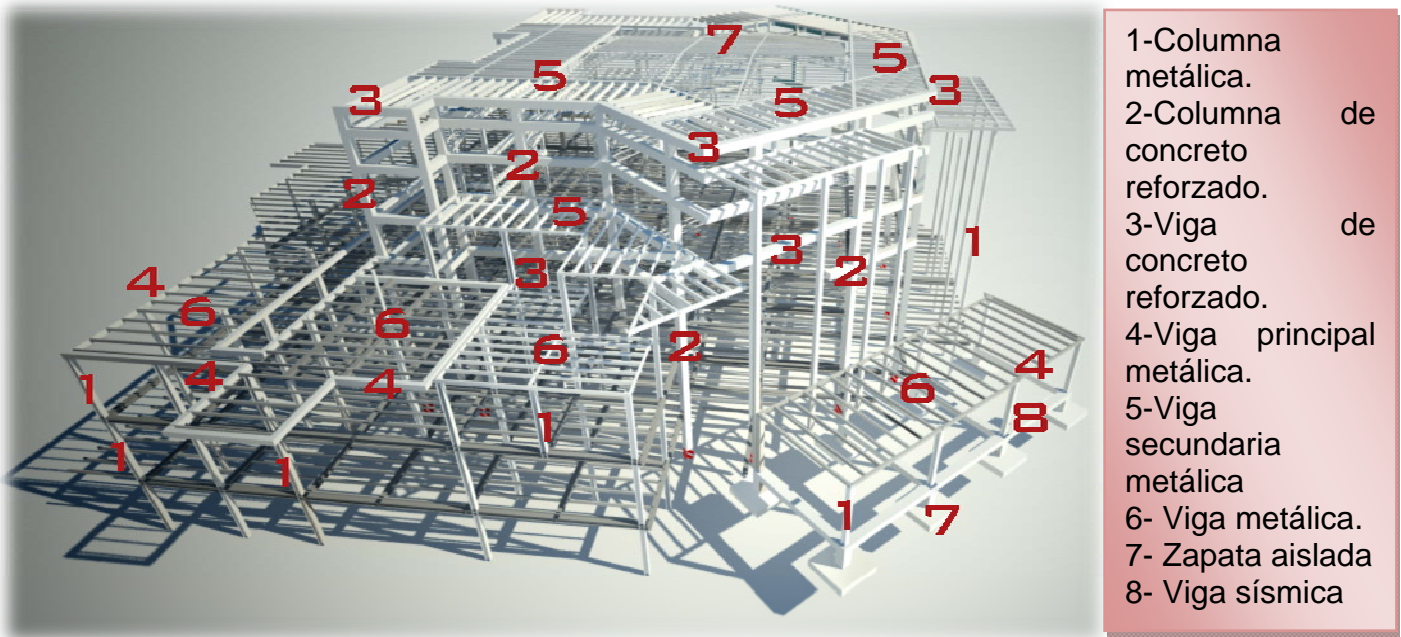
ESTRUCTURA EDIFICIO PRINCIPAL
